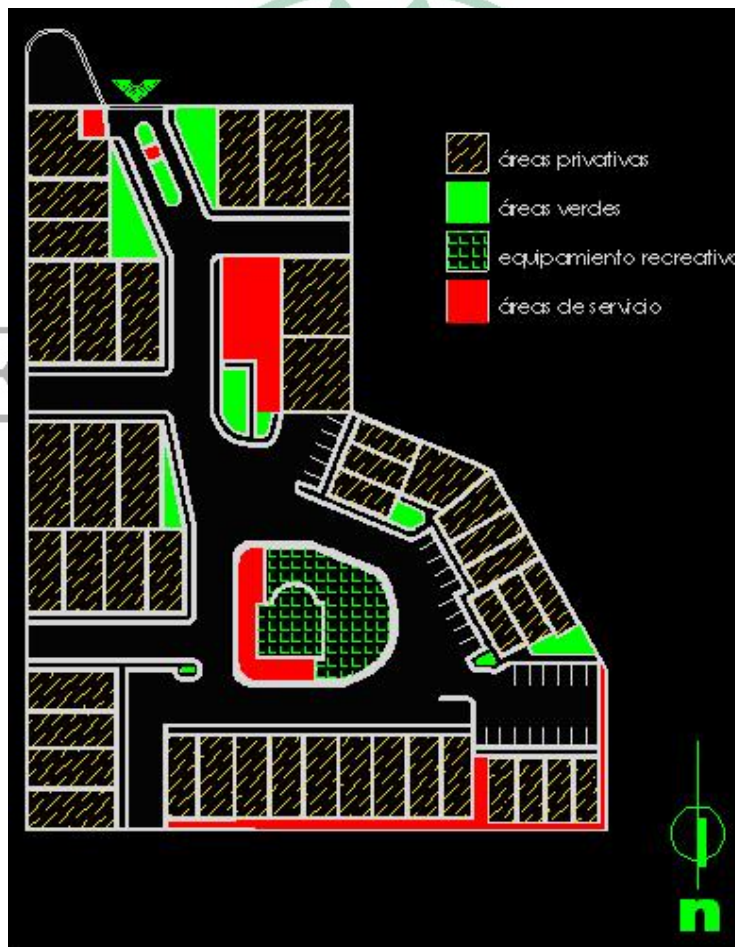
Planta de Conjunto de Residencial Valle Dorado
